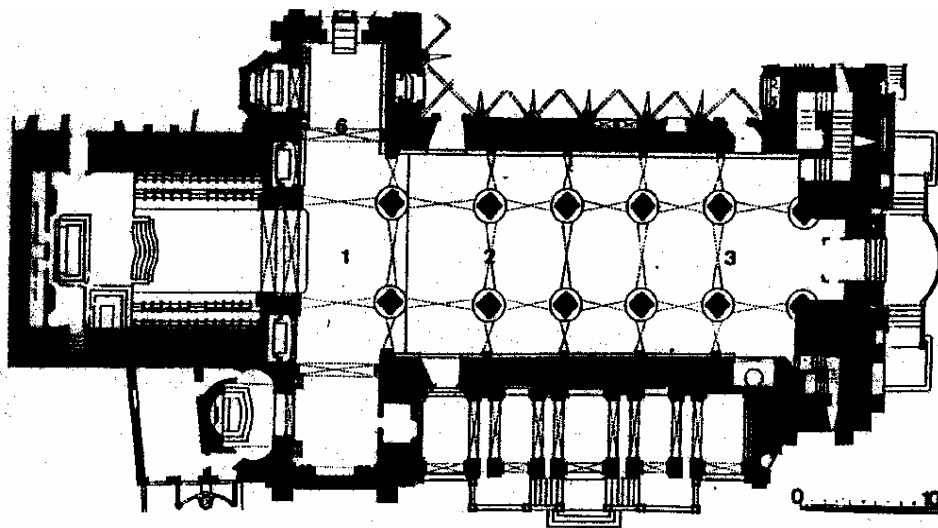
Planta da igreja da Sé do Porto [3]
